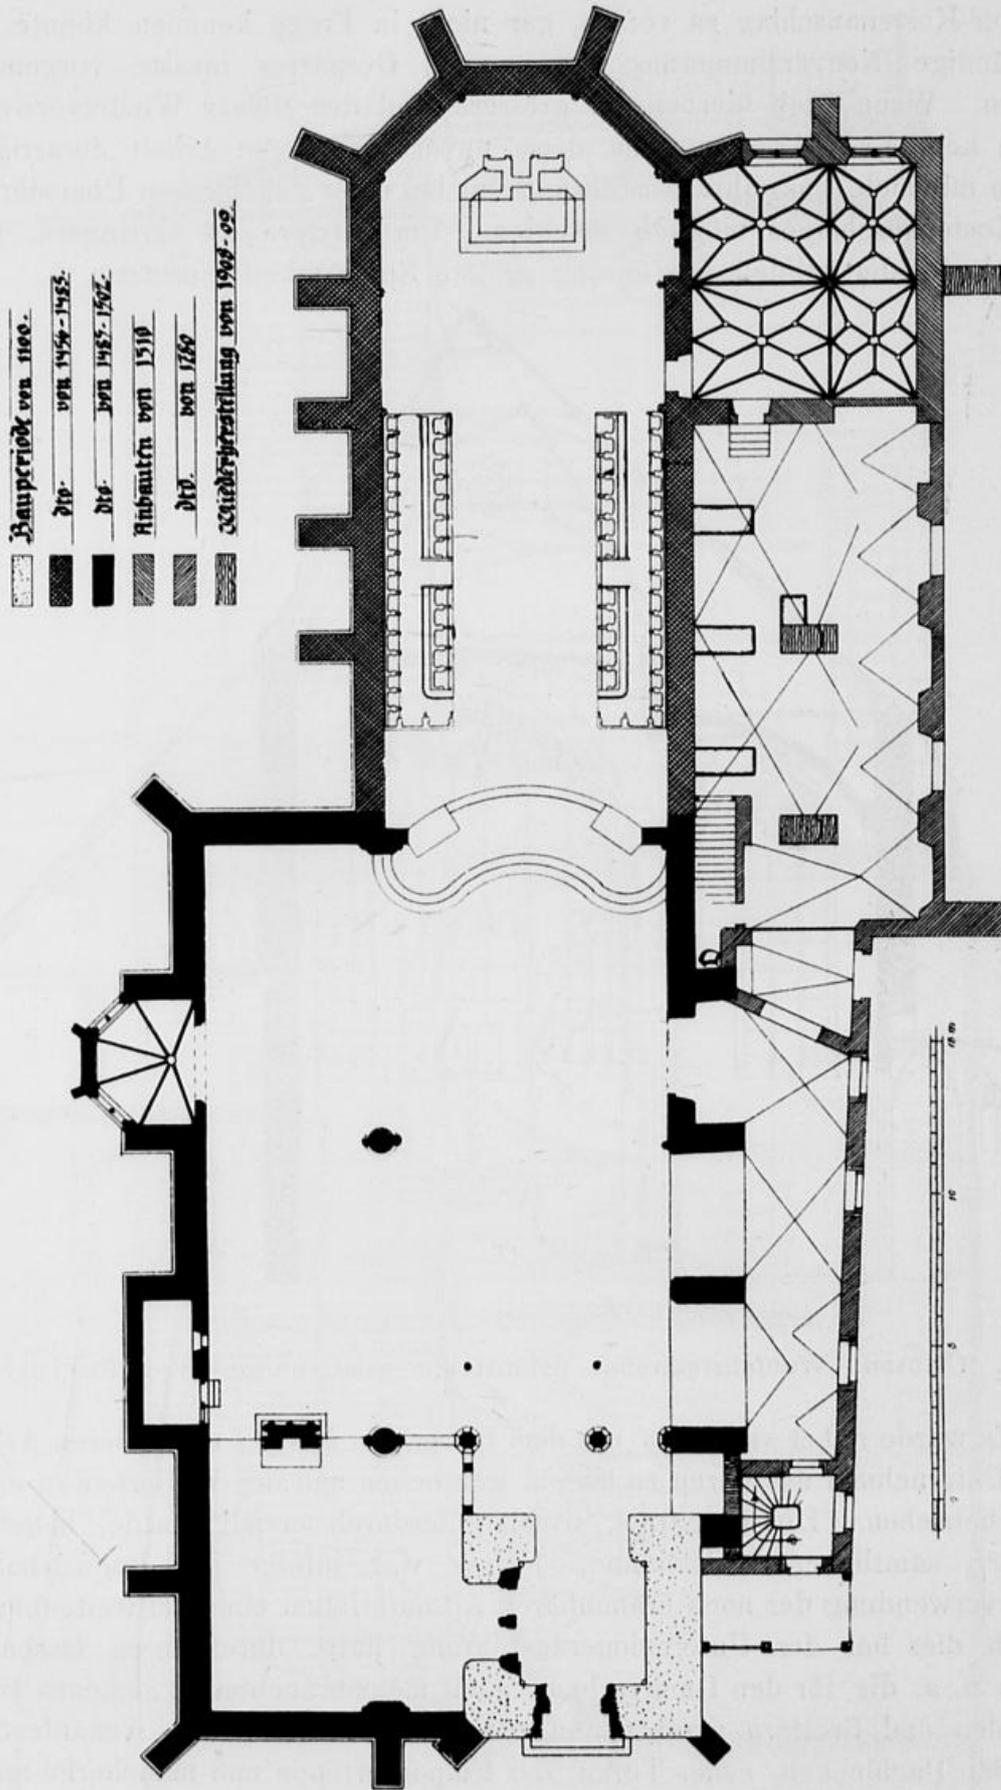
Clausen. Wallfahrtskirche. Unterer Grundriß nach der Wiederherstellung.
